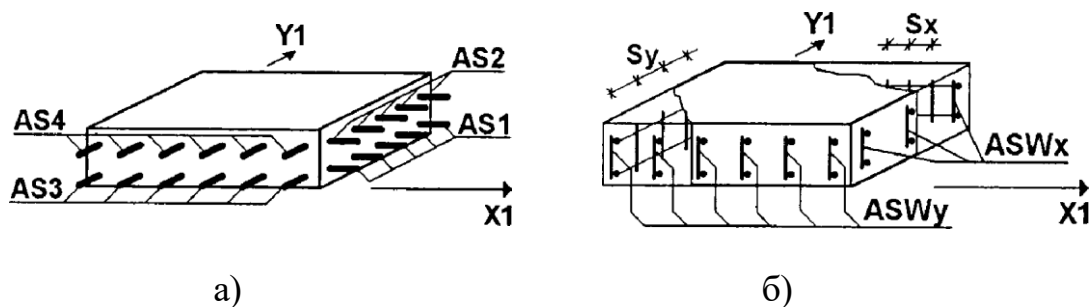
Розташування арматури відносно місцевих осей плит: а) поздовжнє армування; б) поперечне
